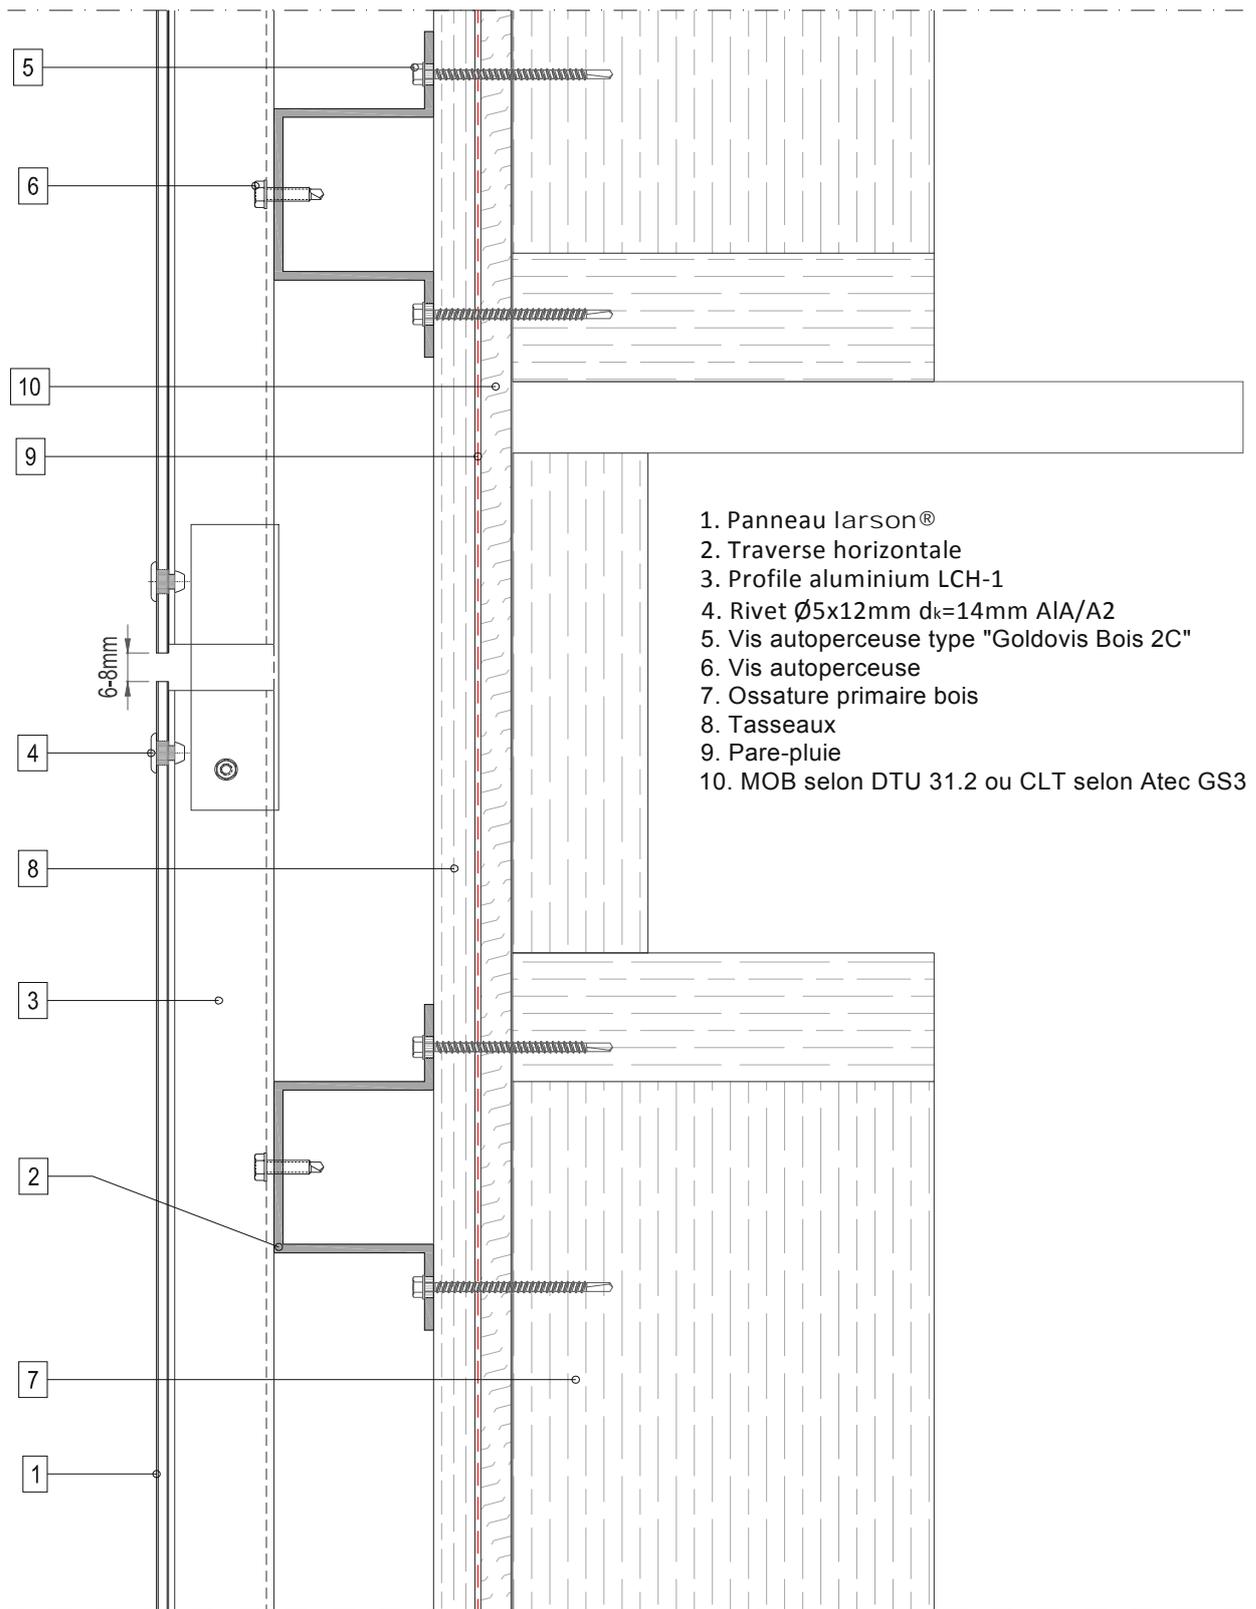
Fractionnement de l'ossature au droit de chaque plancher pour les hauteurs < 10 m
